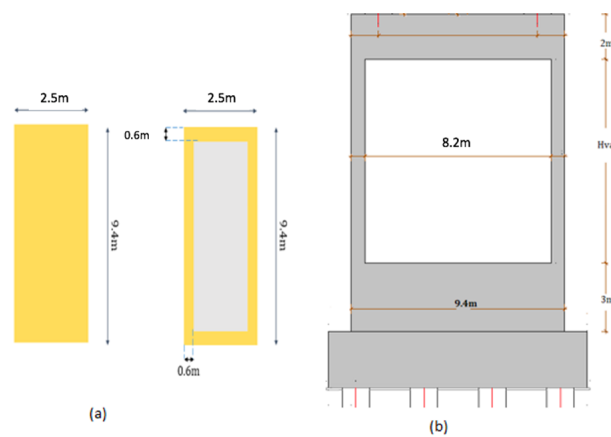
(a) section des piles en plan ; (b) coupe sur pile
